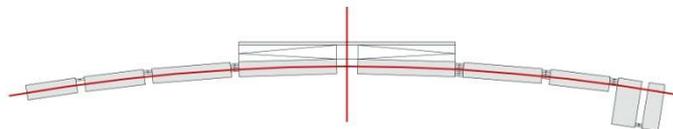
Planta esquemática: eixos estruturantes
